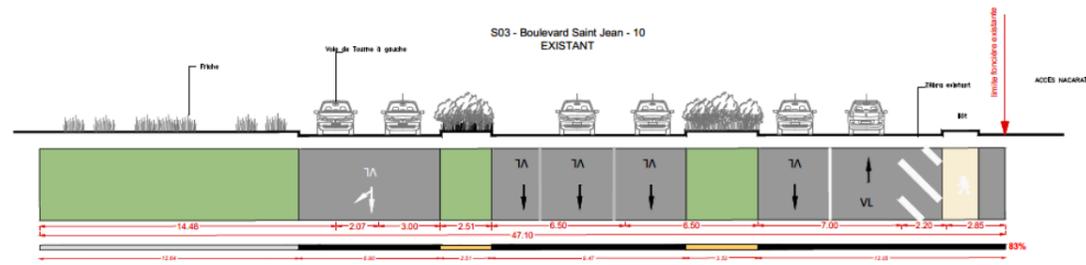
Profil existant du boulevard Saint-Jean au droit de la future ZAC
